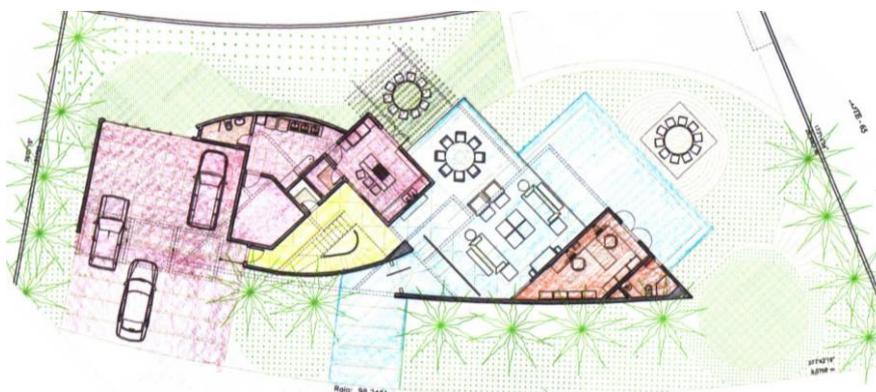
Planta baixa do pavimento térreo (estudo 03)
